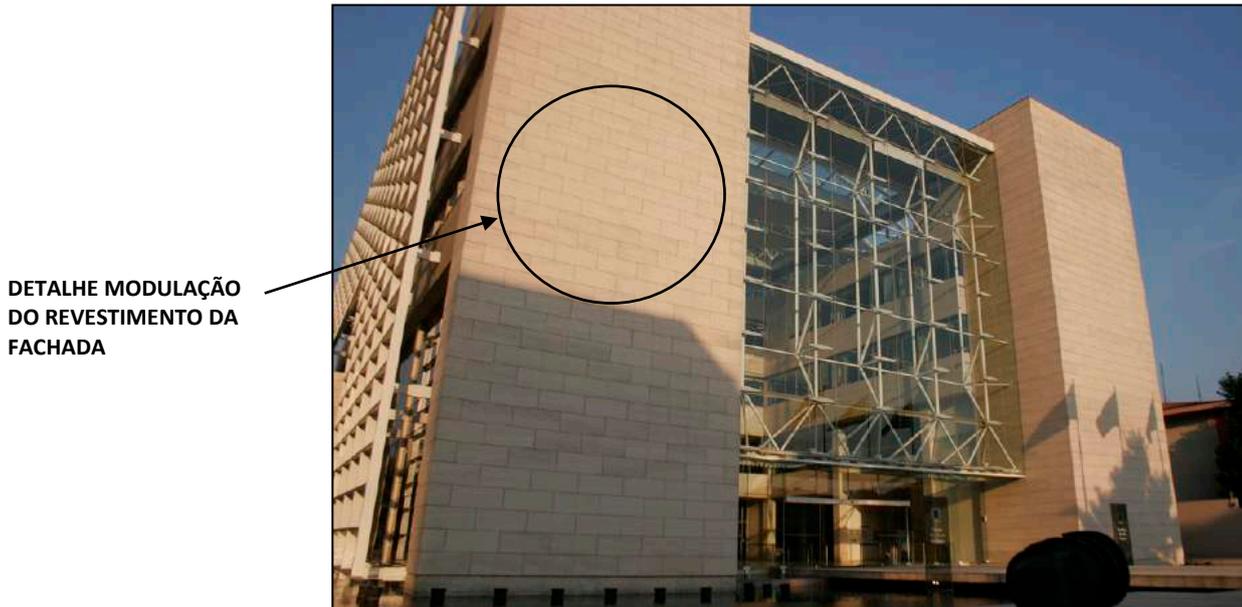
Detalhe modulação 1.25m revestimento das fachadas
